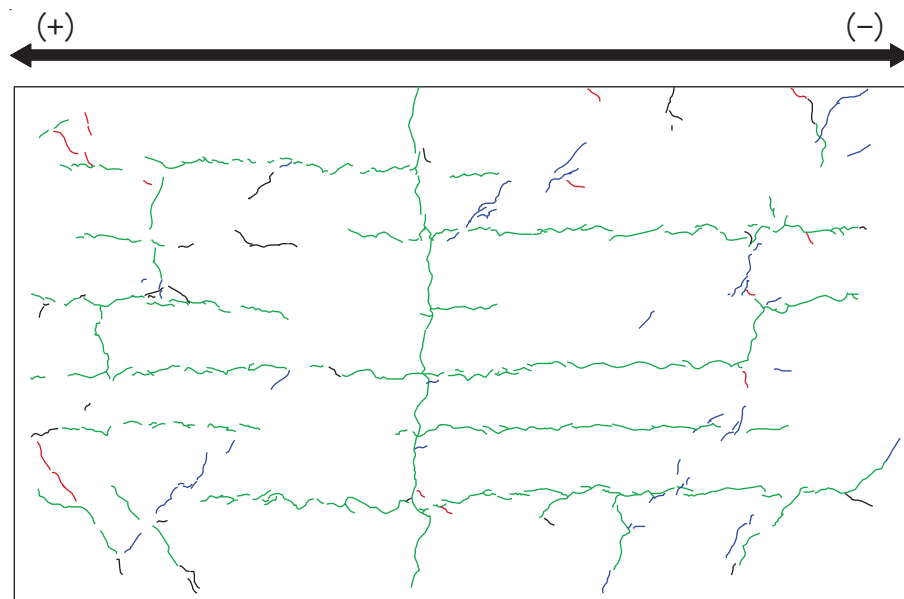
(4) 乾燥試験体 [1] 1/3333rad. におけるひび割れ図
